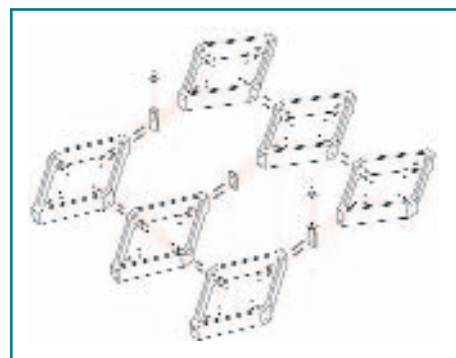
Изометрический чертеж строительного элемента с вмонтированными соединительными деталями для обшивочной конструкции.
